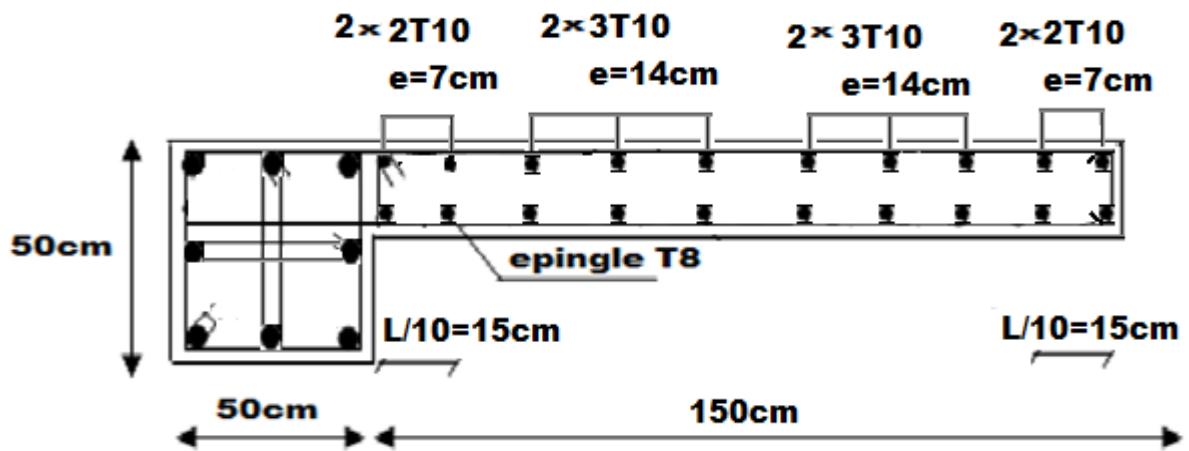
Schéma ferrailage du voile (V4) coupes horizontaux
